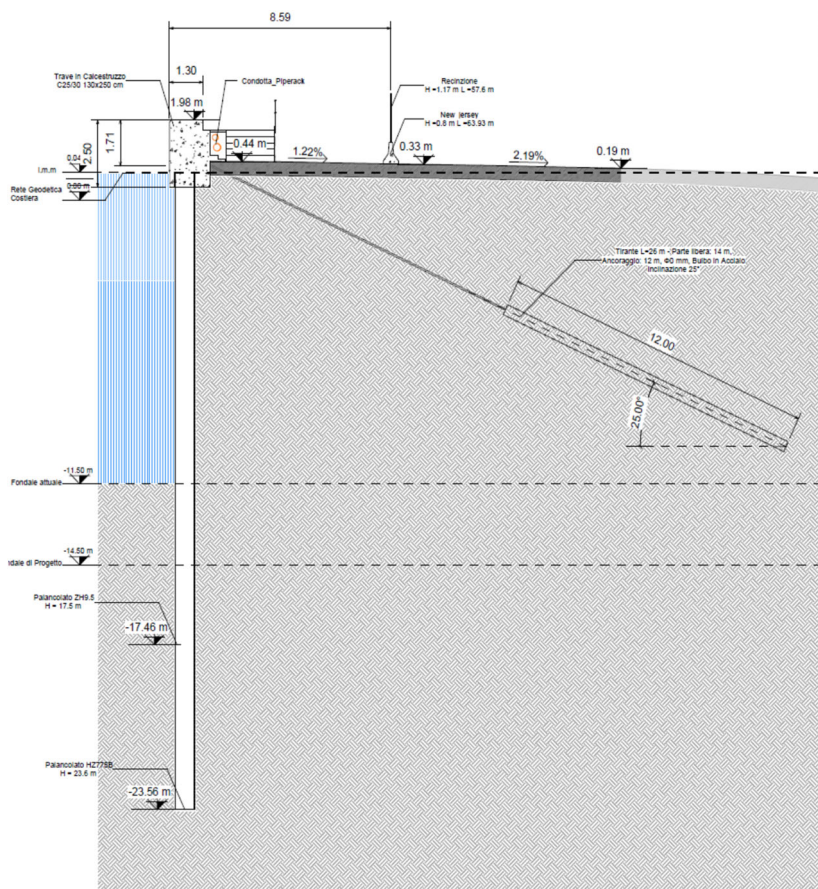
Sezione tipo della banchina Bunge Sud nella situazione attuale
